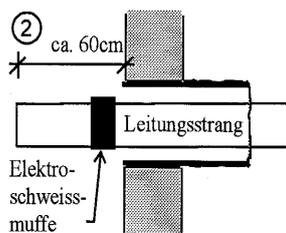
Die Abwasserleitung wird ca. 60 cm weit in den Hauptsammler eingezogen. Eine Elektroschweissmuffe wird angebracht.
